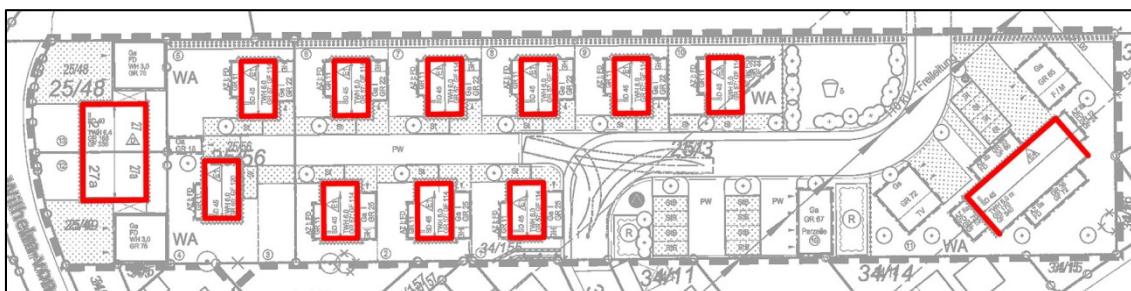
Lageplan mit Kennzeichnung der Fassaden, an denen Schallschutzmaßnahmen im Dachgeschoss erforderlich sind
